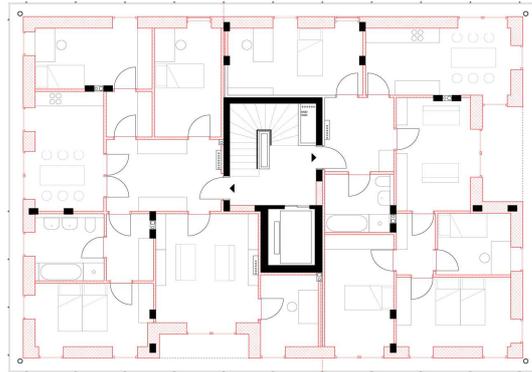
Grundriss 'Grundbau und Siedler' nach Ausbau durch Siedler
